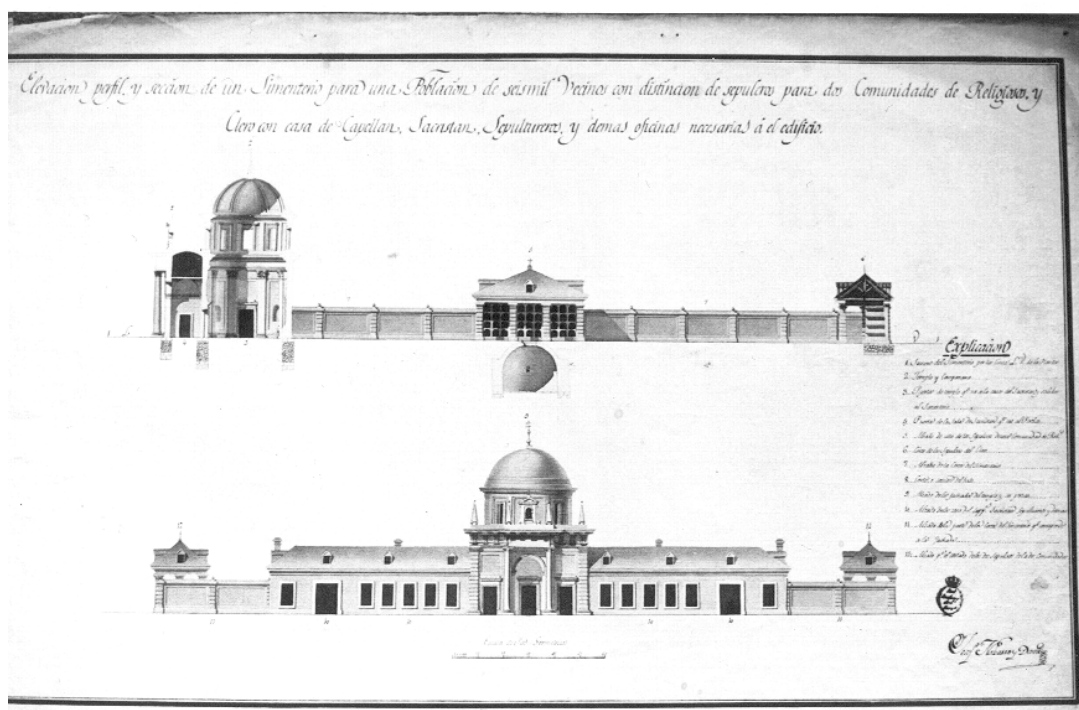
Fachada y sección del proyecto de cementerio para Murcia de José Navarro David
